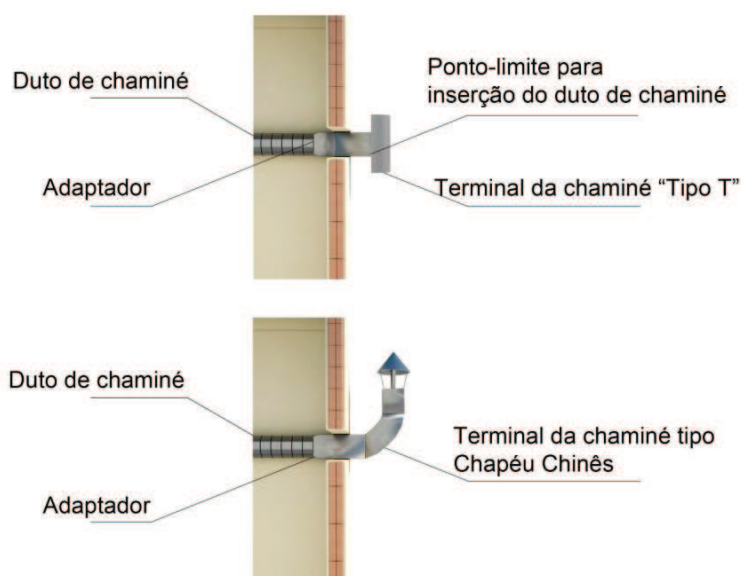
Instalação de chaminé em terminal previamente instalado
